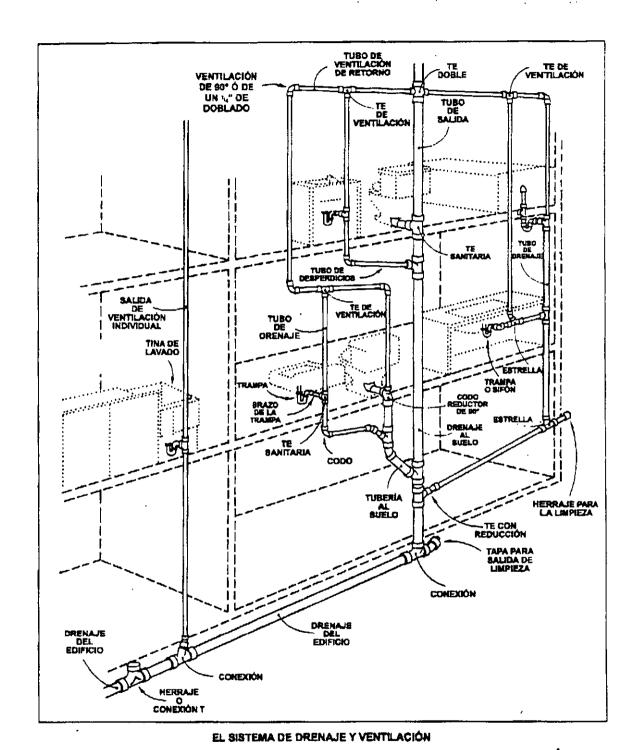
Diagrama tridimensional de un sistema de drenaje y ventilación.
